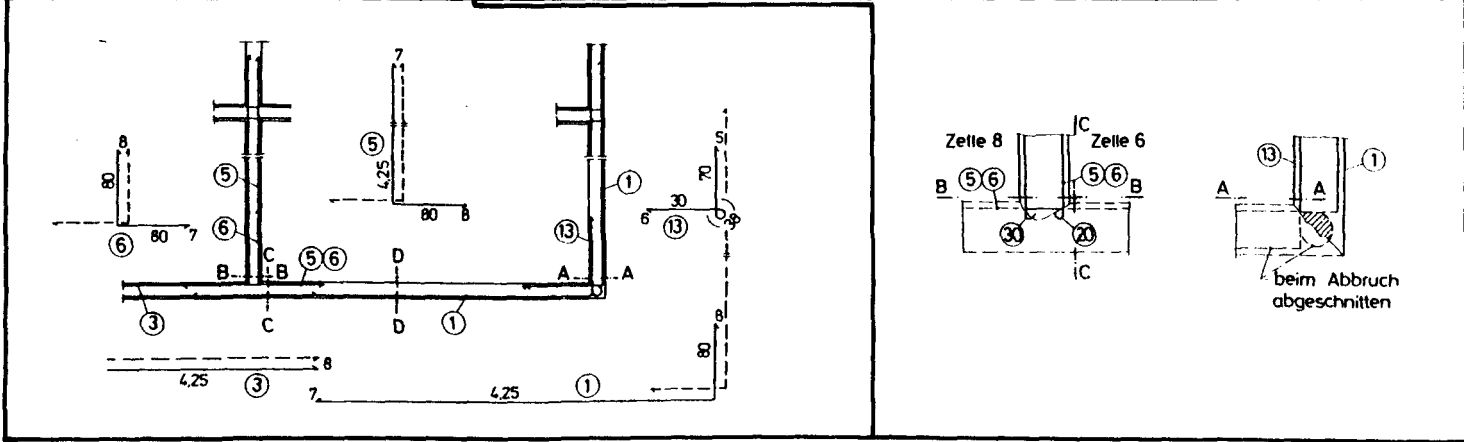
Planmäßige und vorhandene Bewehrung
